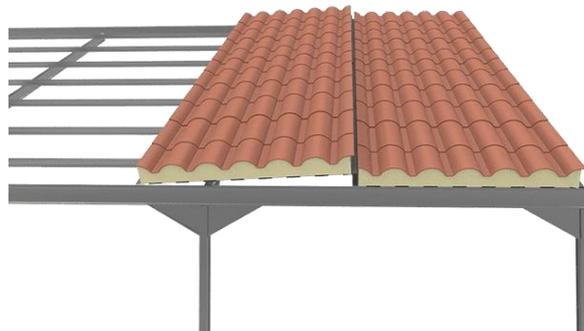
Panel sándwich de tipo teja. (Fuente: panelsandwich.com)
